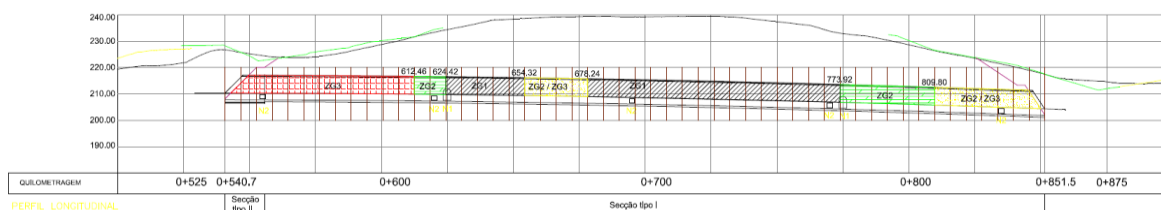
Zonamento geotécnico da fase de construção da galeria Sul
